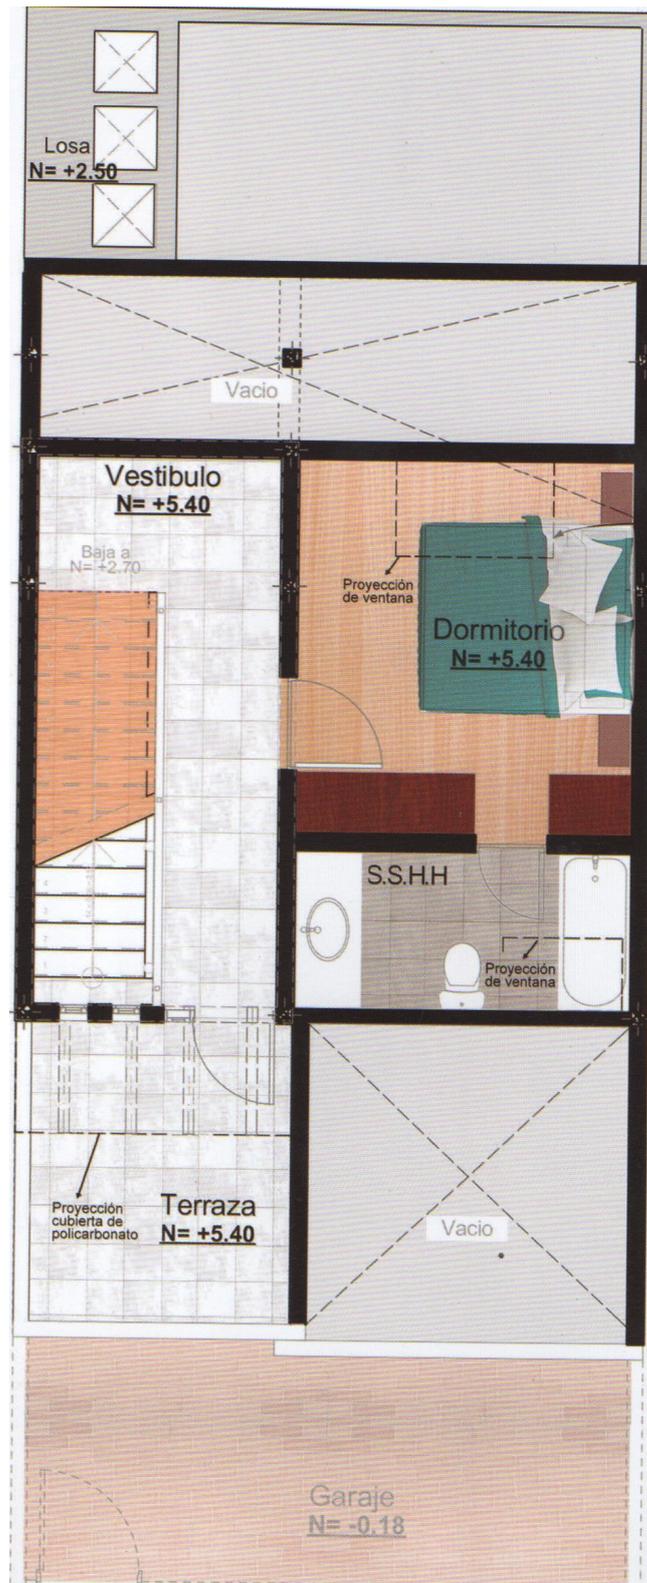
Proyecto de Vivienda Tipo Unifamiliar 90m² – PLANTA ALTA
